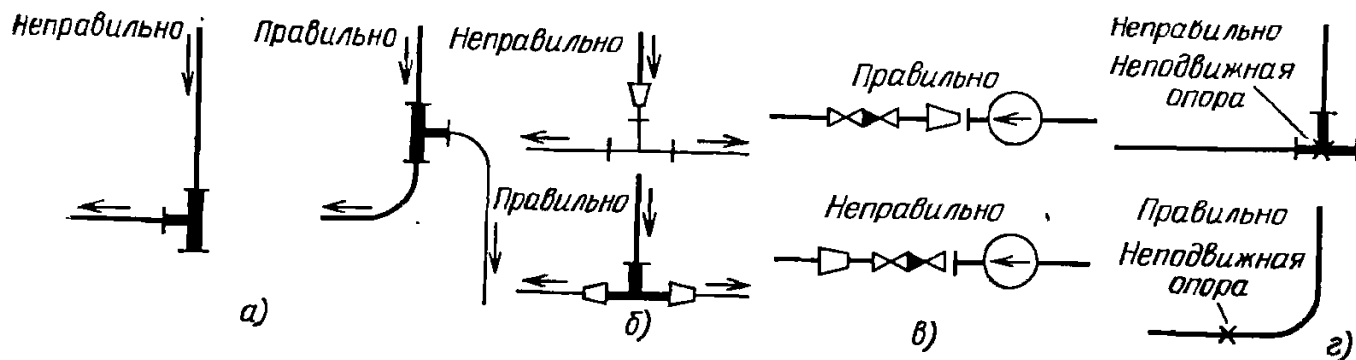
Конструктивные решения, способствующие уменьшению гидродинамических потерь в трубопроводах
